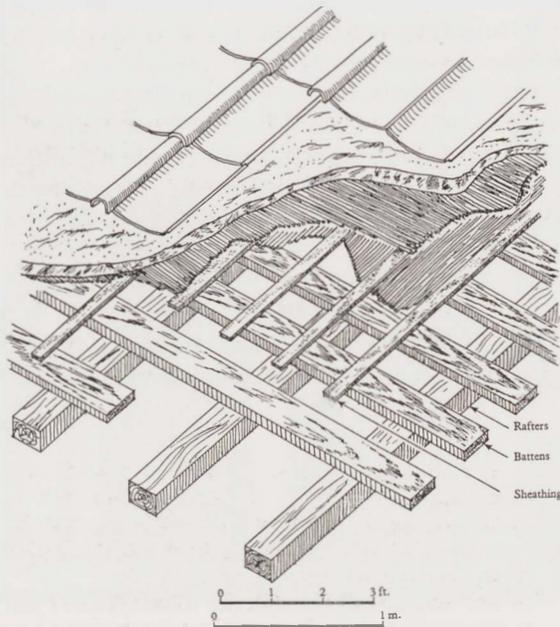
Athen, Stadtmauer. Dachkonstruktion
